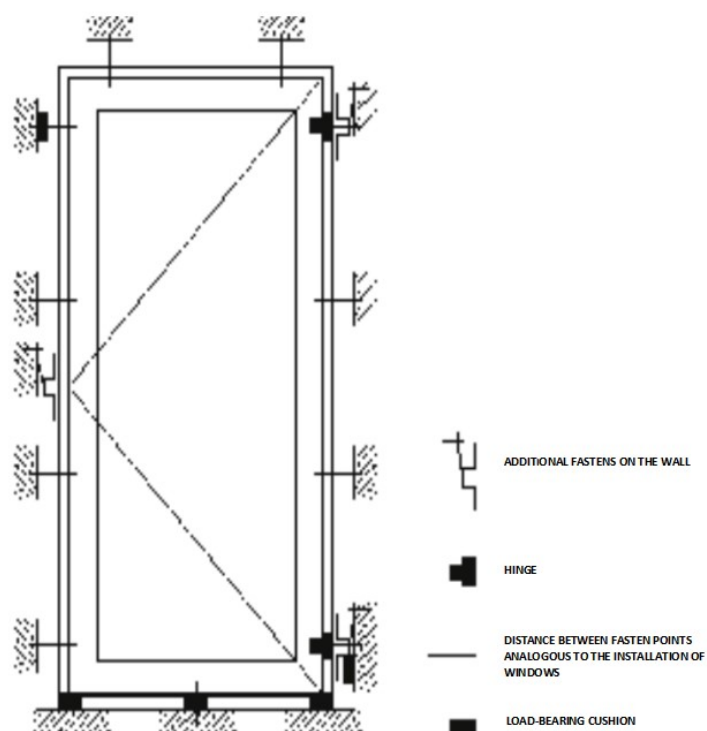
Opstelling van schroeven voor het bevestigen van de voordeur
